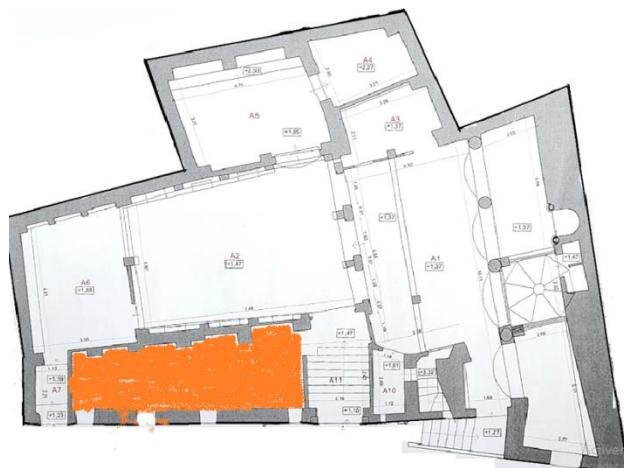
La salle des ablutions Source : Fond de plan Rocca, traitement auteure
